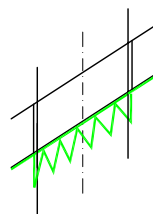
DETAIL DACHDURCHFÜHRUNG (Schmutzwasserentl., Kamin, o.ä.)
